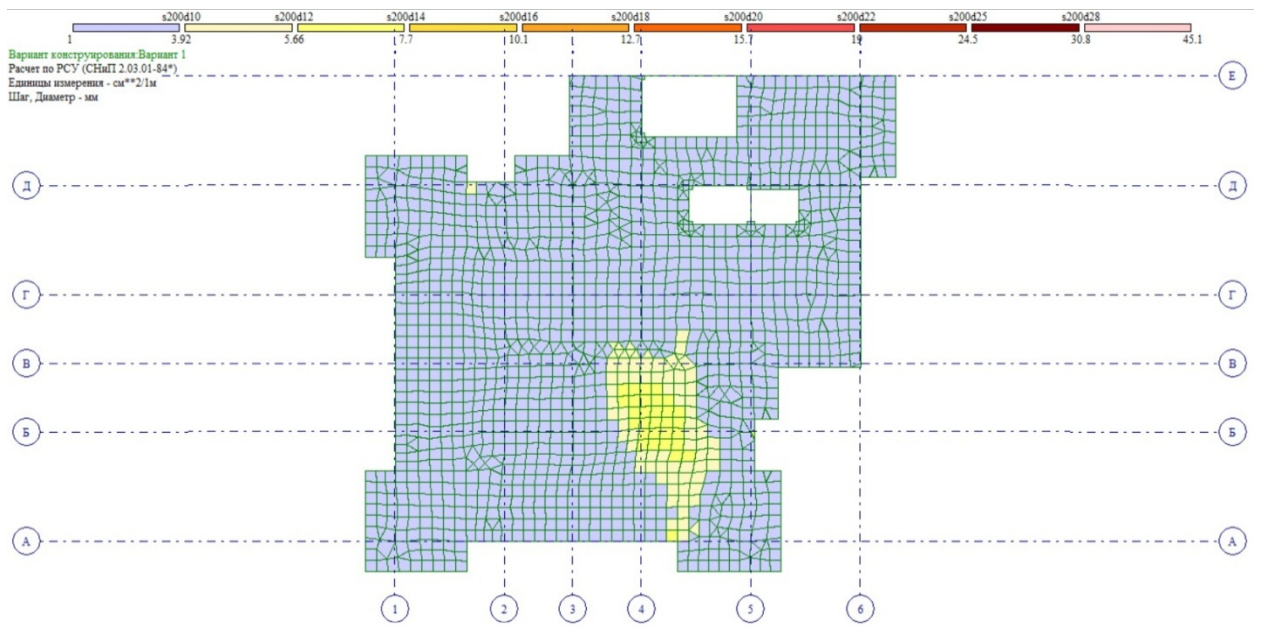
Нижнее армирование плиты вдоль оси X
